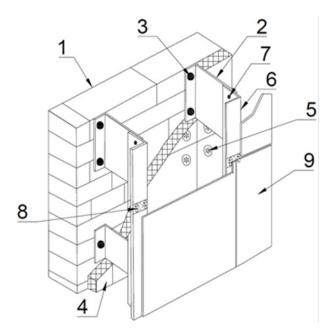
Конструкция навесной фасадной системы: 1 – ограждающая конструкция; 2 – кронштейн; 3 – фасадный анкер; 4 – утеплитель; 5 – тарельчатый дюбель; 6 – Г-образная направляющая; 7 – саморез/ заклепка; 8 - кляммер; 9 - облицовка керамогранитом
